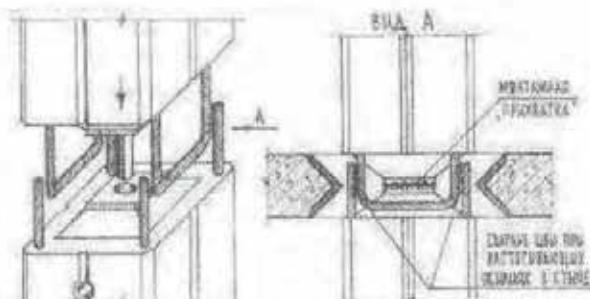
Схема соединения колонн при их наращивании и стык соединения колонны с надколонной плитой
